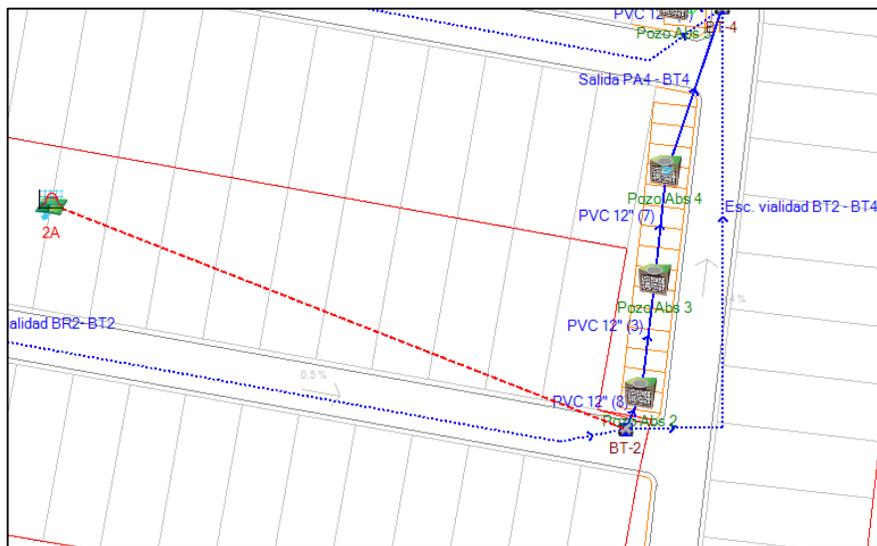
Vista en planta de los pozos de infiltración 2,3 y 4. Fuente: xpdainage.
